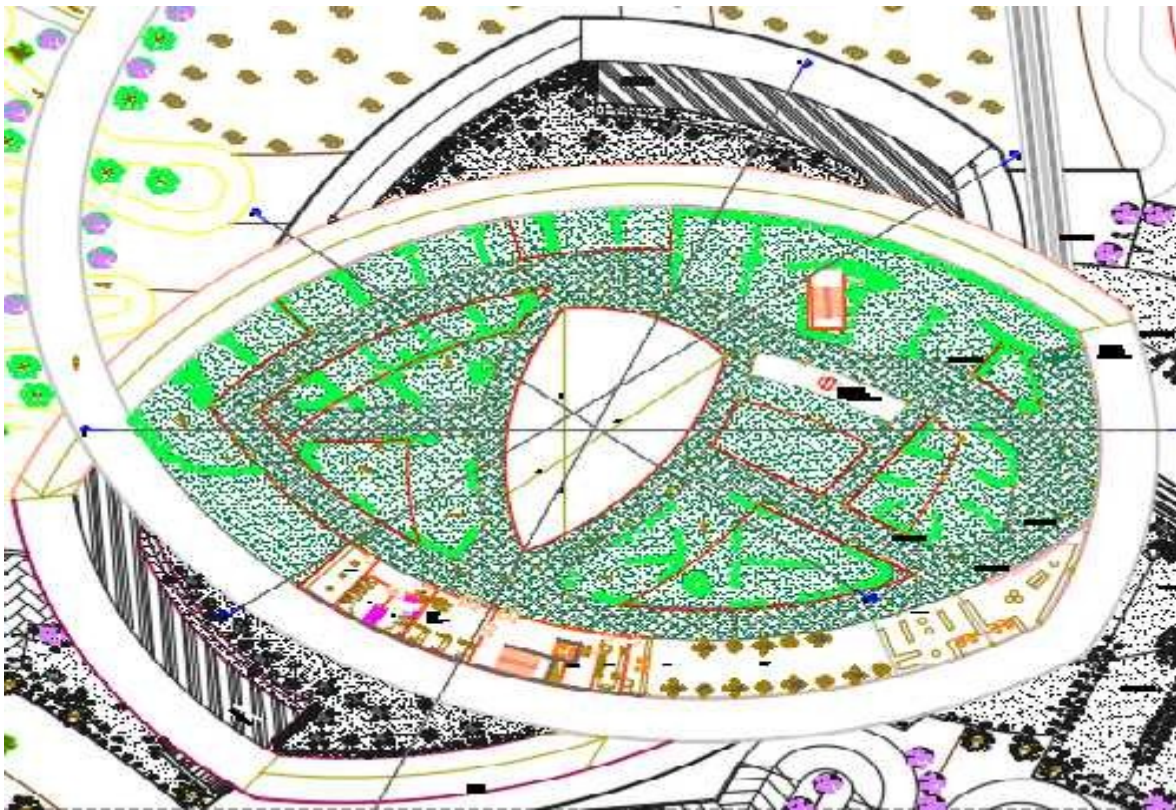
Planta 3 o Planta Techo Nivel 755.80m. (2017)
